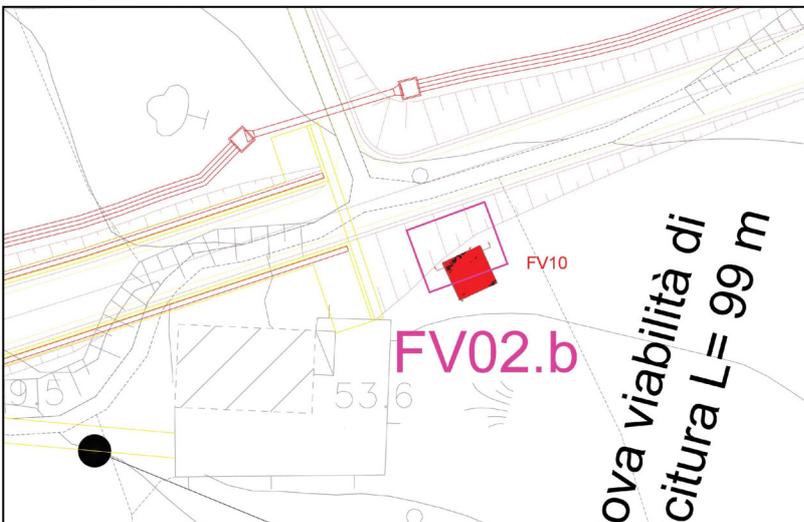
Stralcio planimetrico con l'area di estensione dello scavo di seconda fase di FV02b
